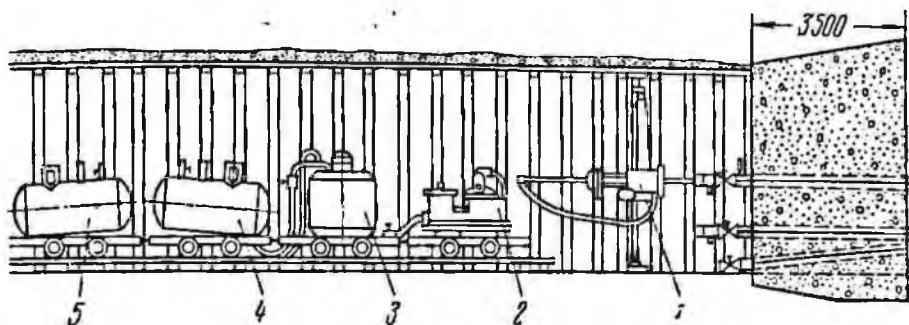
Схема расположения оборудования при предварительном тампонаже из забоя горизонтальной выработки:
